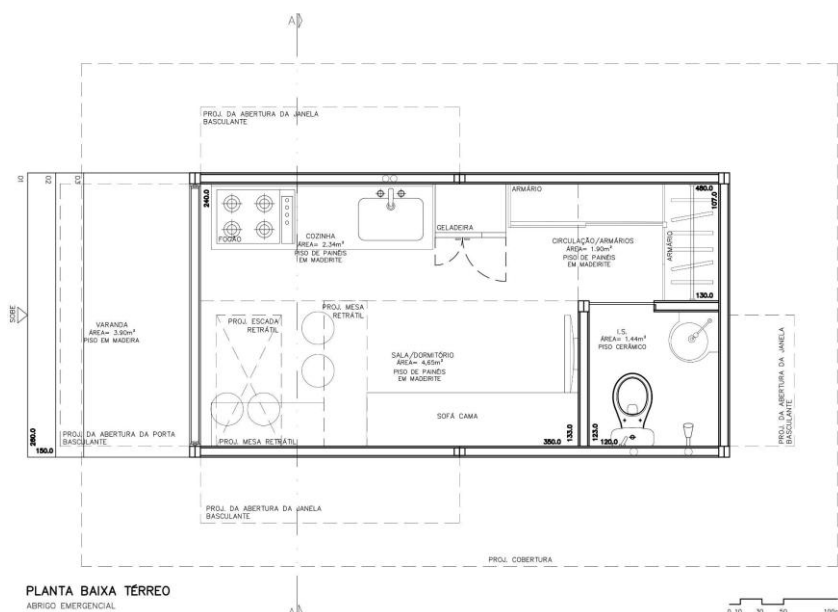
Planta Baixa - Térreo. Fonte: Autoras (2025).
